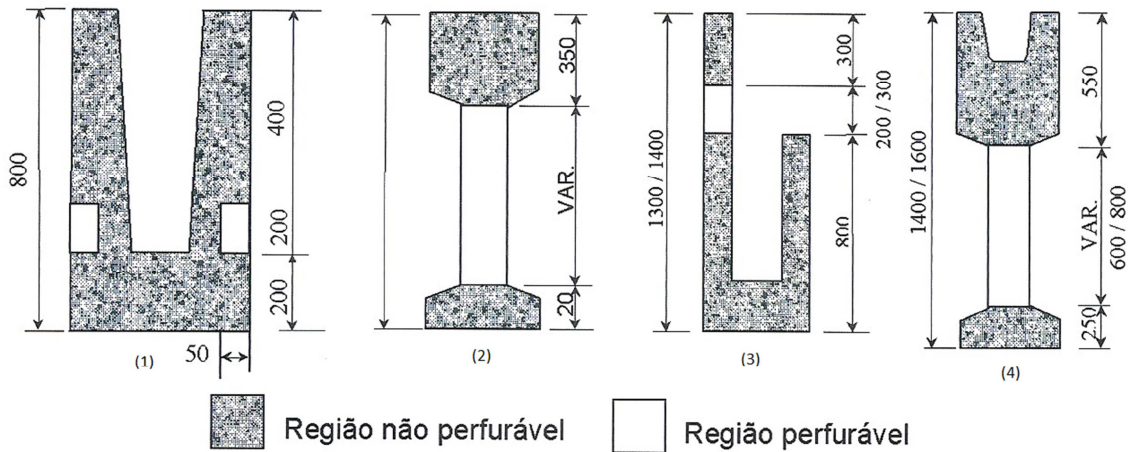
Indicação de furos em vigas pré-moldadas U, I, J e calha
